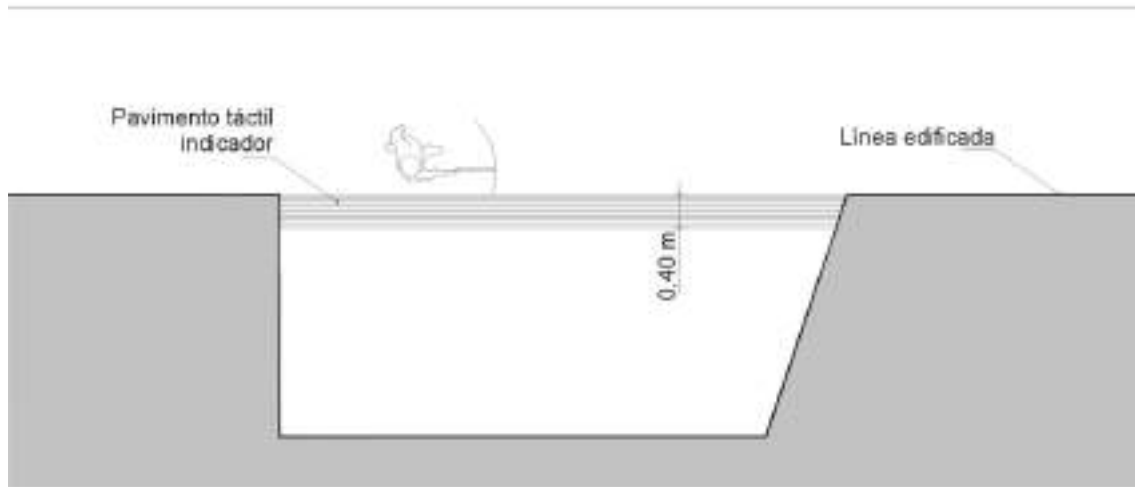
Franja de pavimento táctil indicador direccional que da continuidad a la línea edificada
